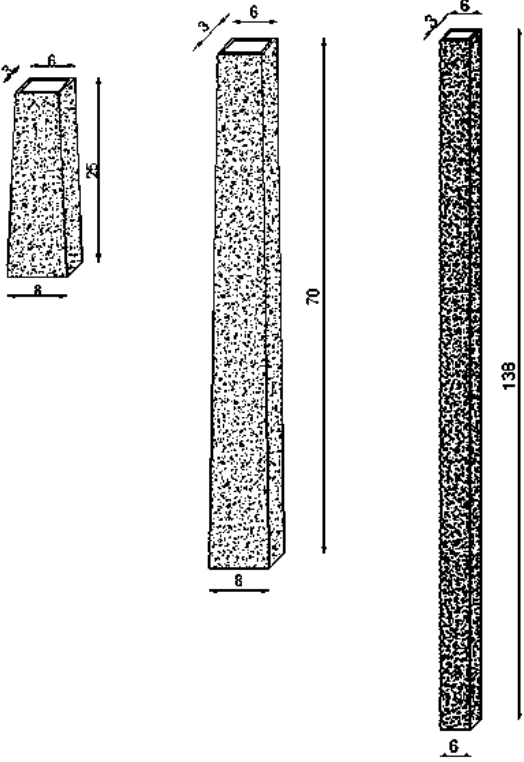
b Dimensiones de las pilas que se utilizaron en el modelo. Cotas en metros.
